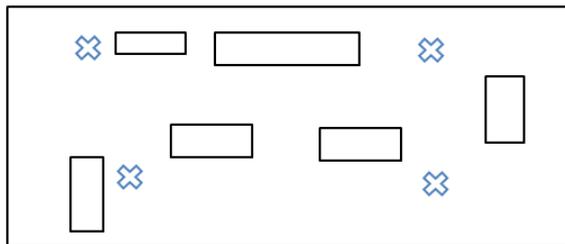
Denah Pencahayaan Pada Gedung Gudang
